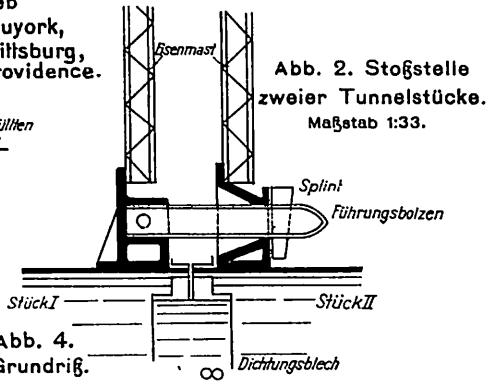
Stoßstelle zweier Tunnelstücke. Maßstab 1:33.
